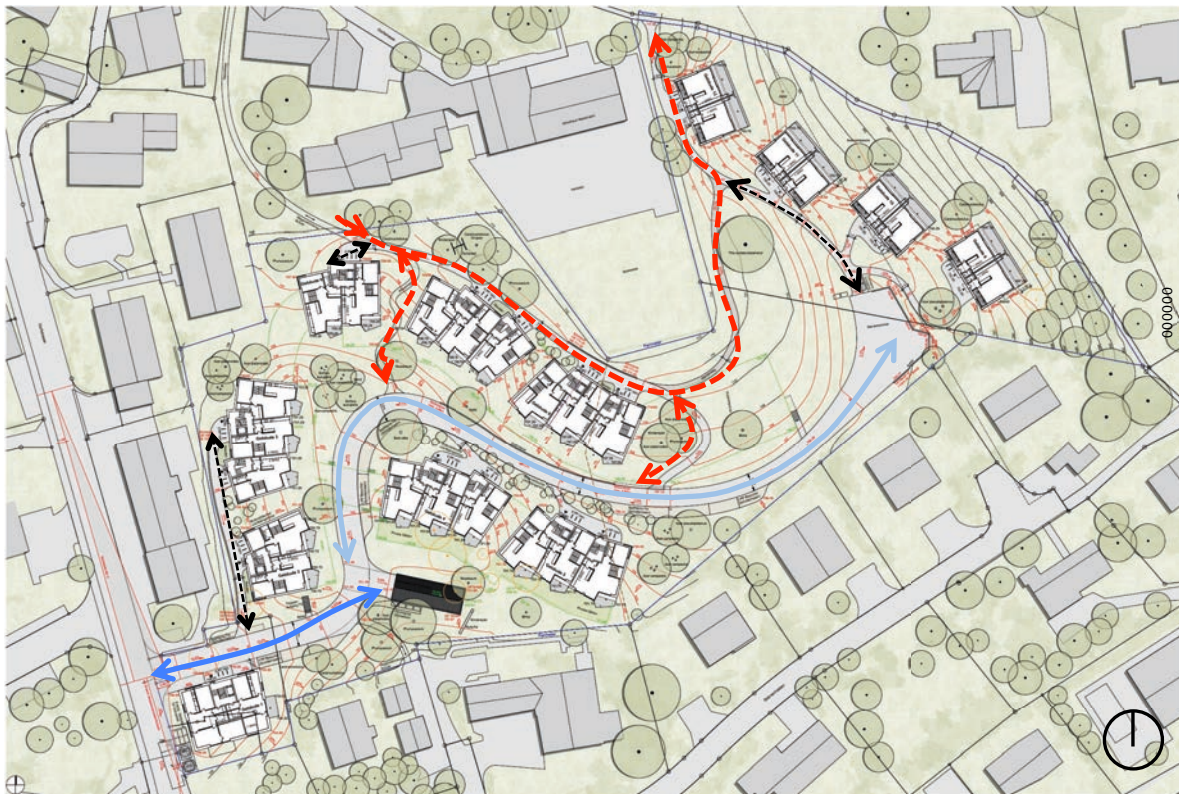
Erschliessung mit Anschluss an die Dorfstrasse, Abschnitt bis Garageneinfahrt (dunkelblau), Abschnitt bis Häuser 9 bis 12 (hellblau), öffentliche Fusswegverbindungen (rot); interne Fusswegverbindungen (schwarz)
